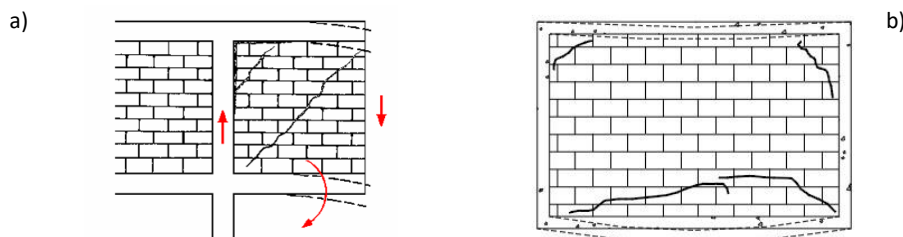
Fissuras típicas em alvenaria de vedação causadas pela deformação da estrutura de concreto armado: a) devido à deflexão da viga de concreto armado na região em balanço; b) devido à deformação da viga inferior maior que a viga superior.
